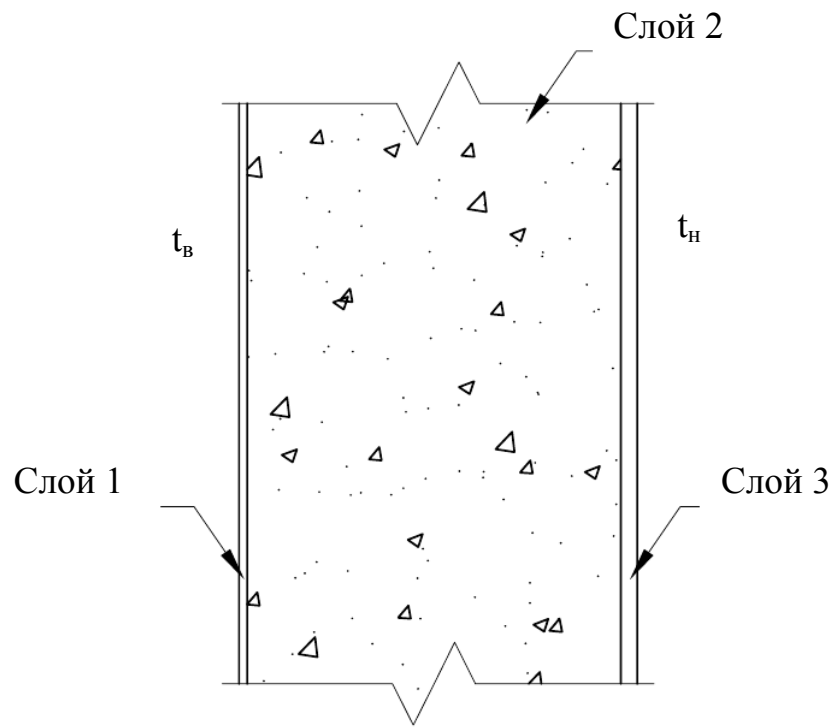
Расчетная схема ограждающей конструкции стены
